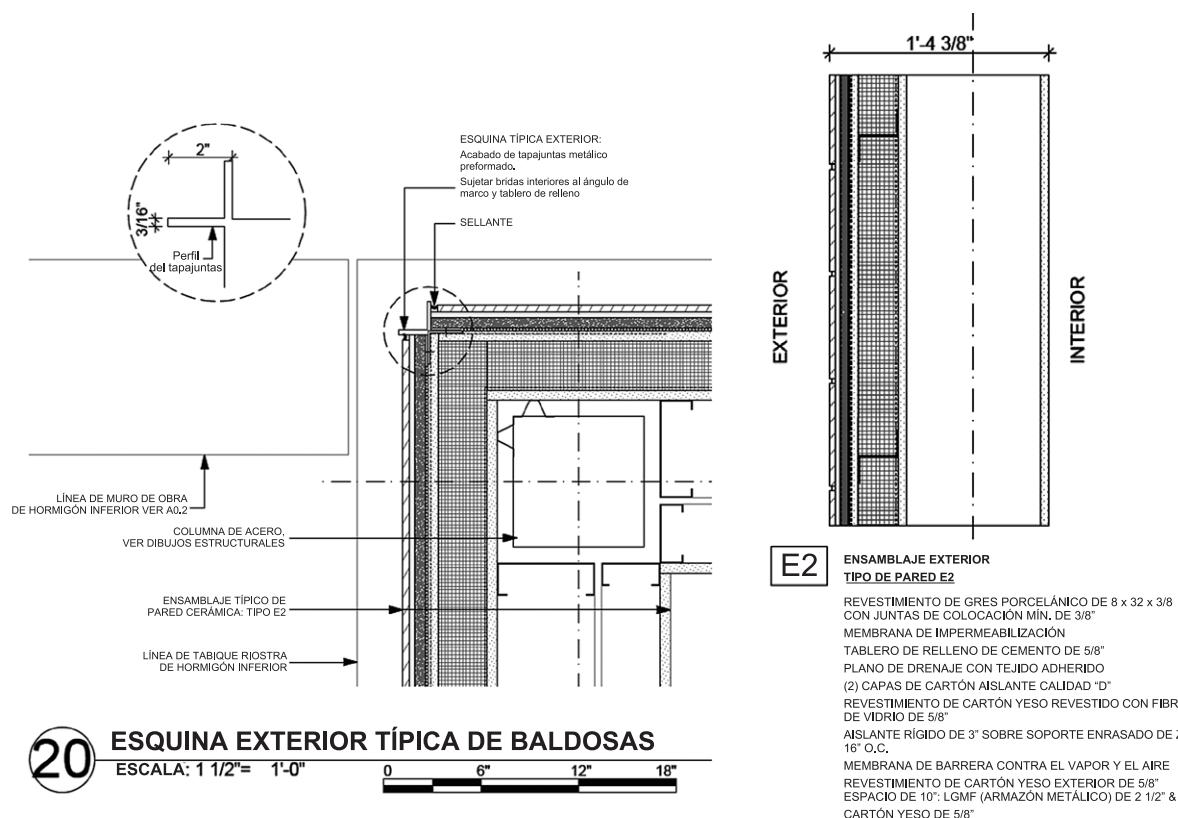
El plano de drenaje interior detrás del ensamblaje de revestimiento cerámico de pared puede impedir las eflorescencias y los daños en climas con temperaturas bajo cero
